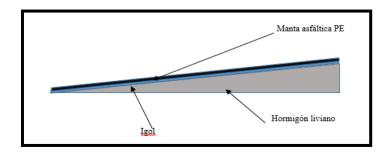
Detalle de la impermeabilización en la azotea.
